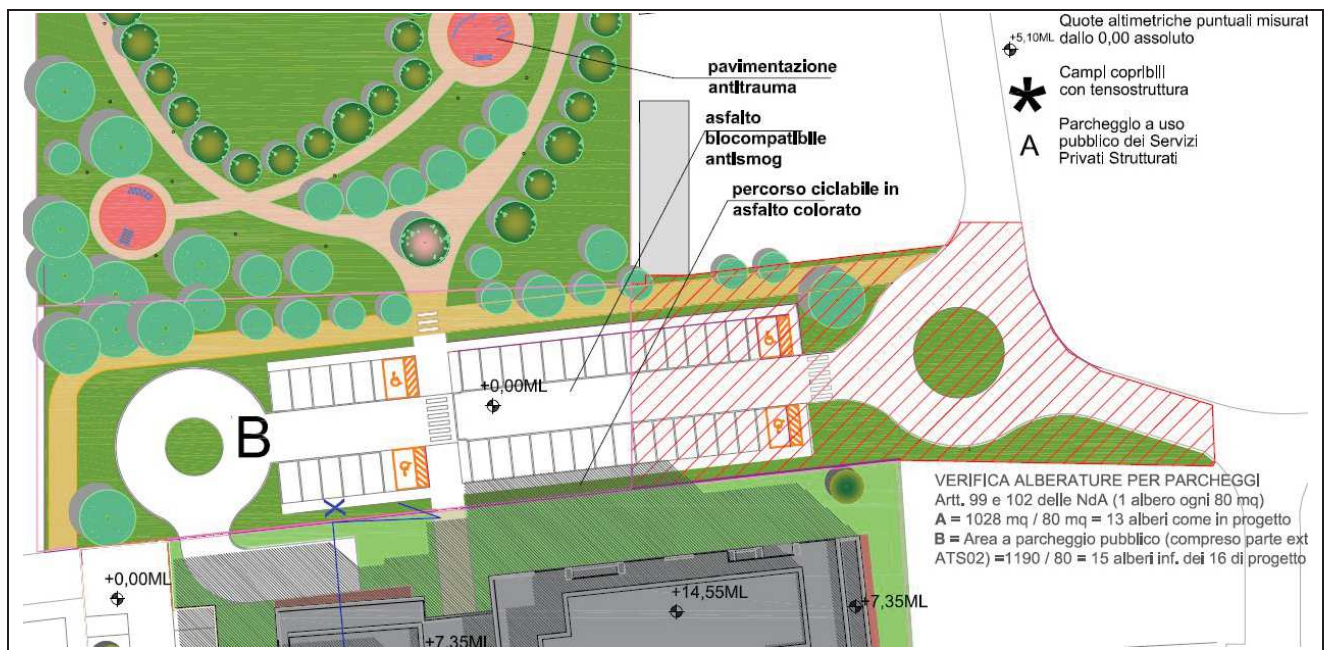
collegamento viabilistico di progetto alla via Baranzate
